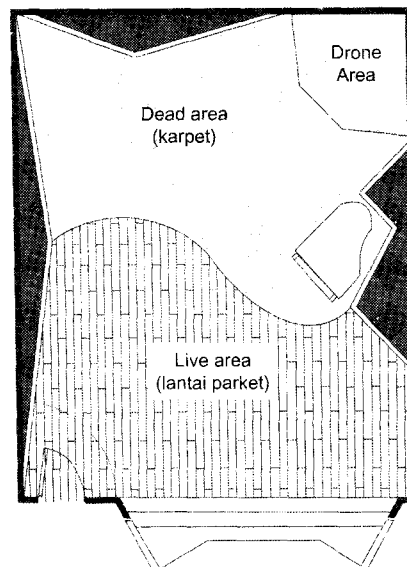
Contoh denah studio yang memakai sistem ruang di dalam ruang
